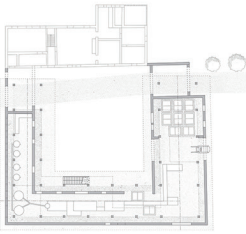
Plan rez-de-chaussée, échelle 1:200
